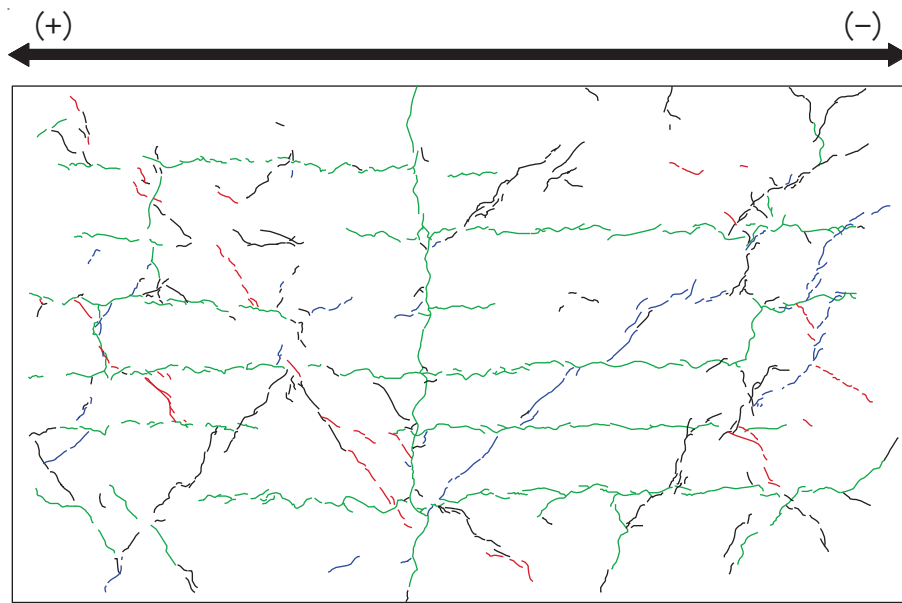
(6) 乾燥試験体 [1] 1/1667rad. におけるひび割れ図
